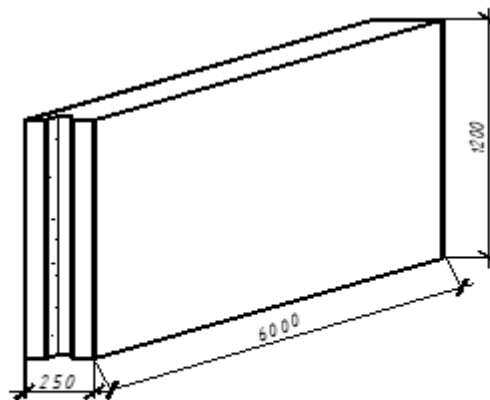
Керамзитобетонні панелі зовнішніх стін
